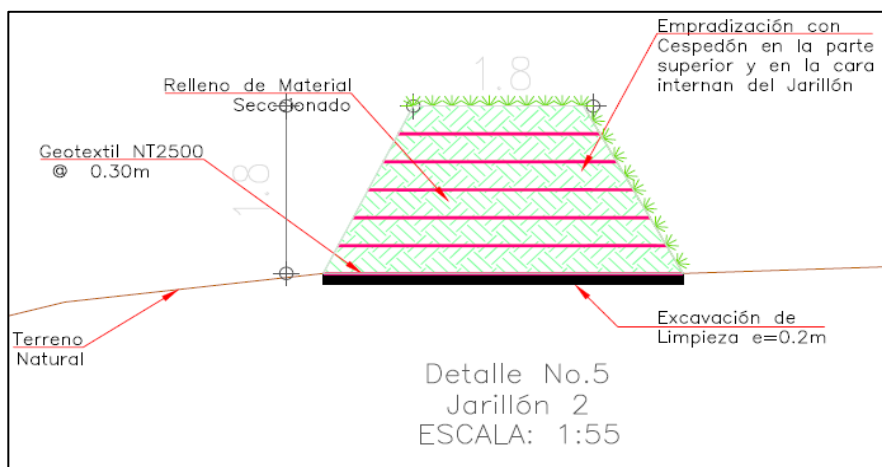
Detalle de jarillón perimetral sobre PTAR.
